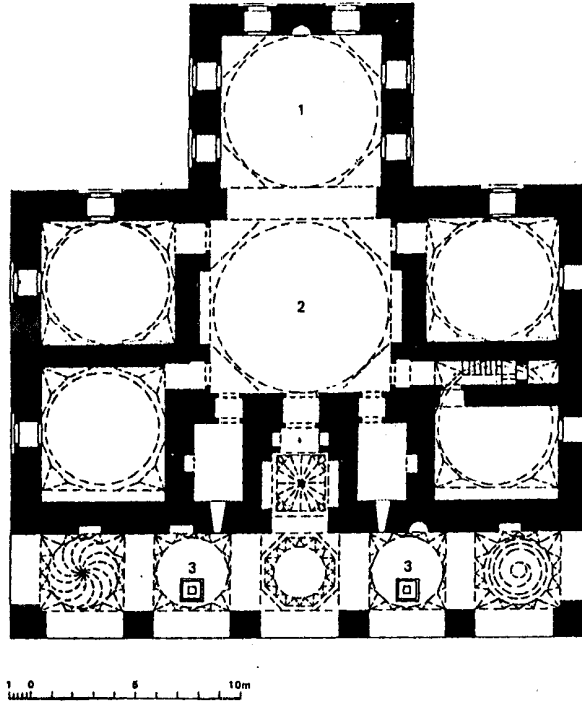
مسقط أفقي لجامع المرادية في أدرنه (عن : Kuran)
